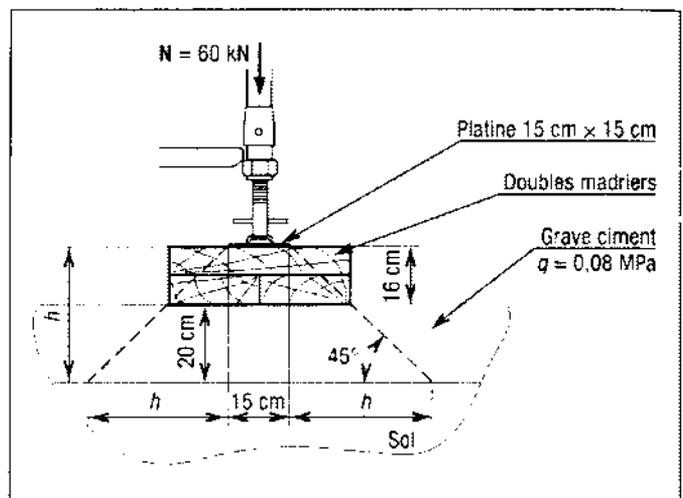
Exemple de répartition des charges sur une grave ciment.
